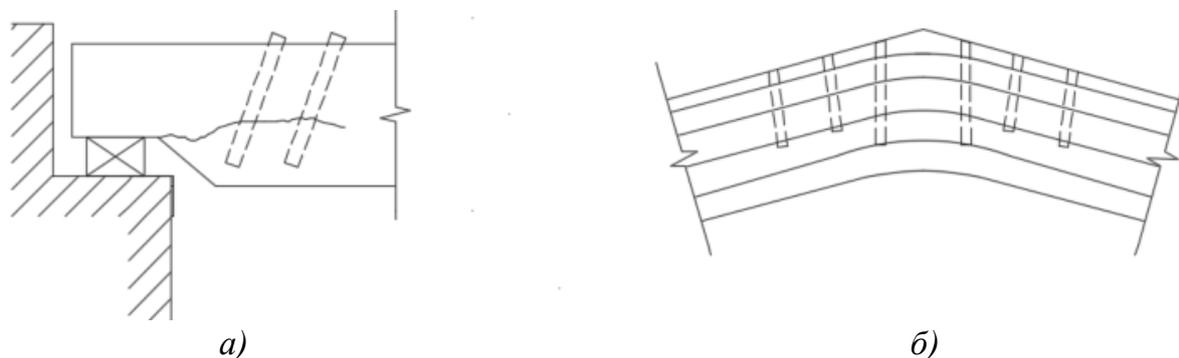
Усиление балок вклеенными стержнями: а – для восприятия сдвиговых усилий; б – для восприятия растягивающих усилий
